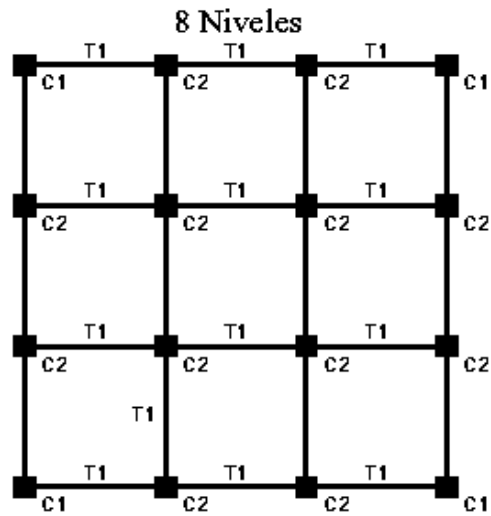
Clasificación adoptada para las secciones de columnas y traves para el marco de 8 niveles.
